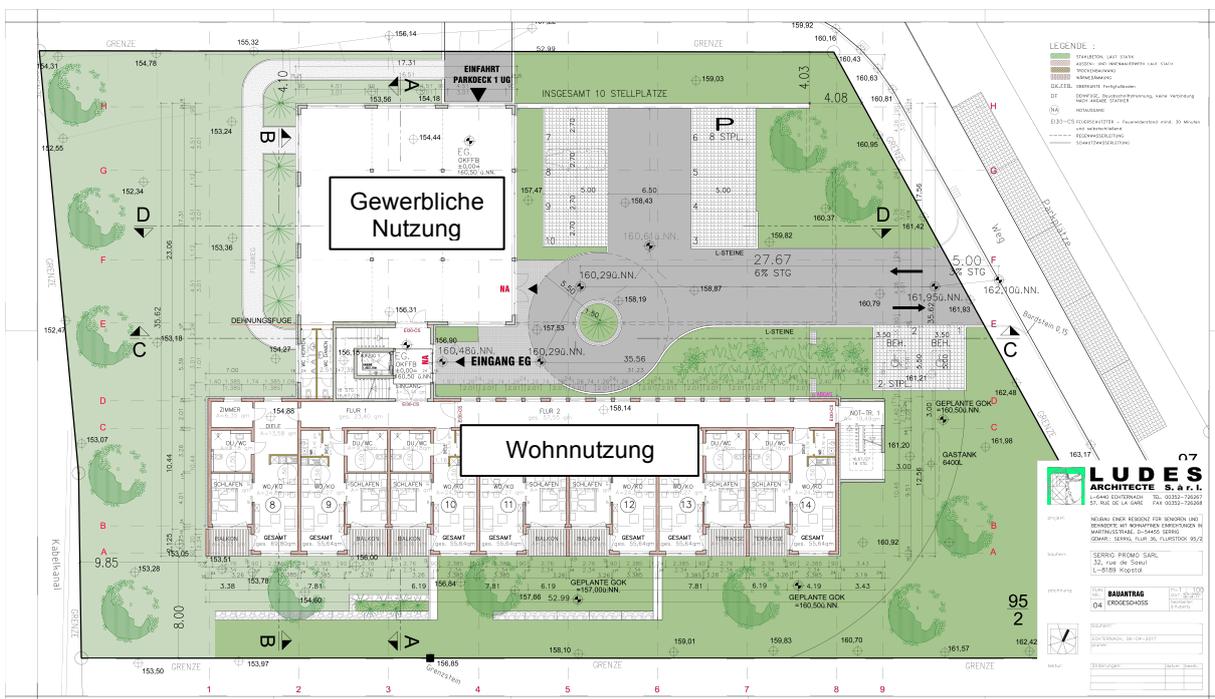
Grundriss des Bauvorhabens Planung April 2017 (ohne Maßstab) /7/
